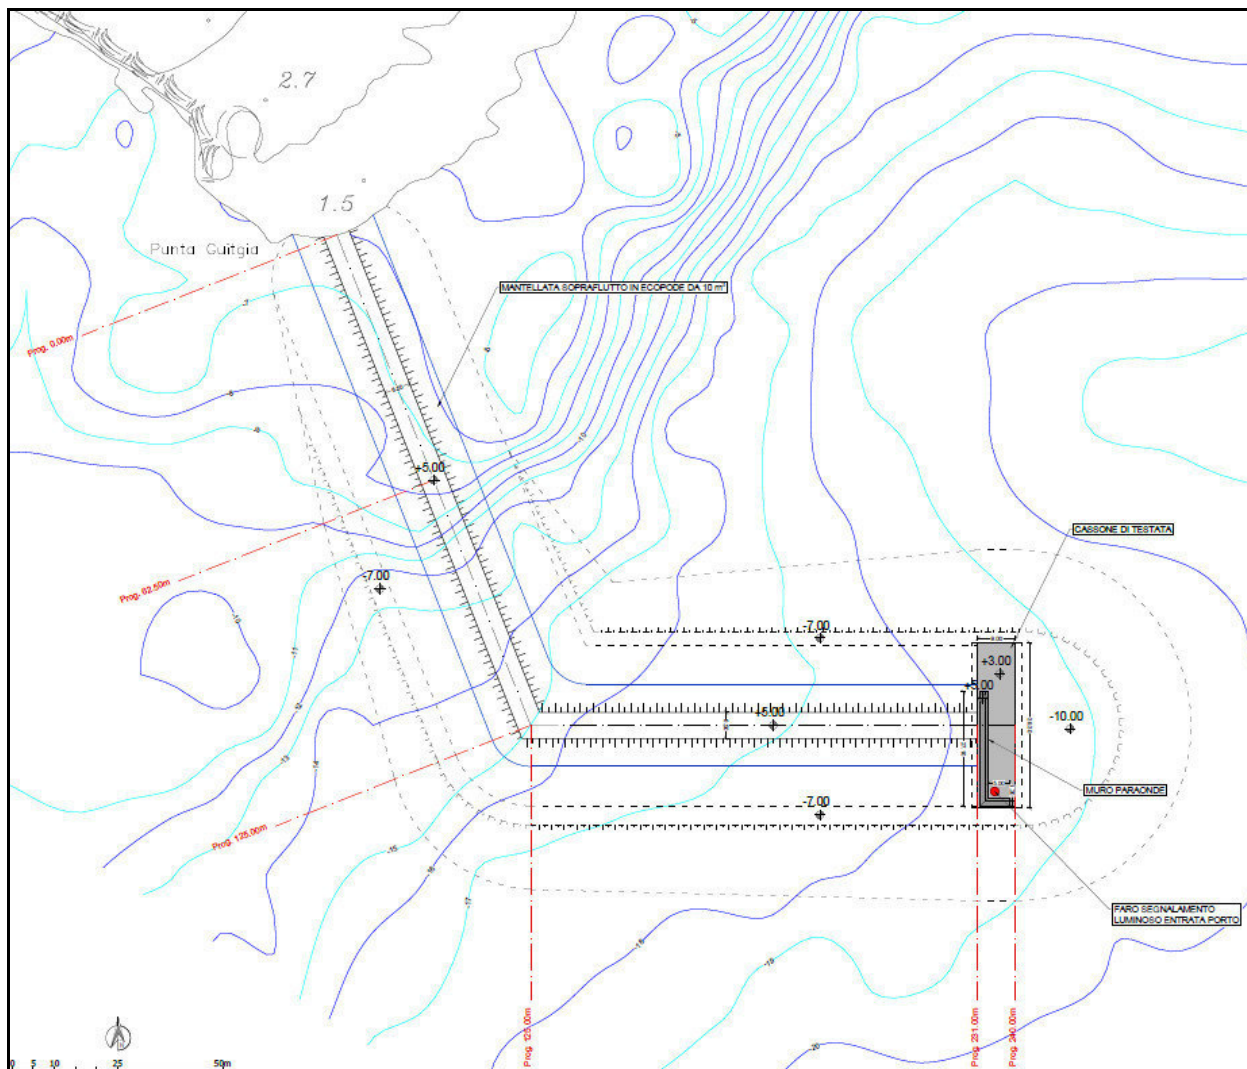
planimetria di progetto della diga foranea (fuori scala)
